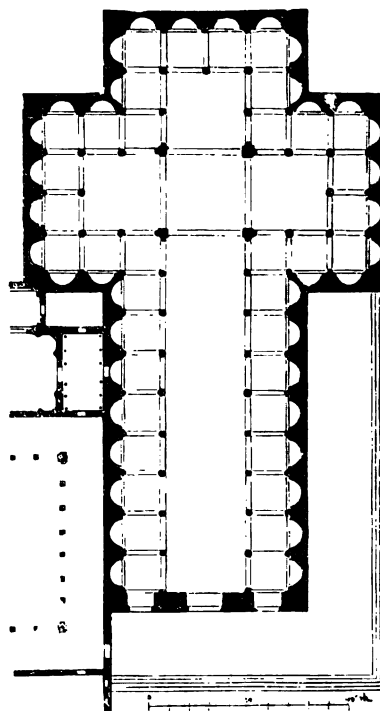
S. Spirito zu Florenz. Grundriss.
